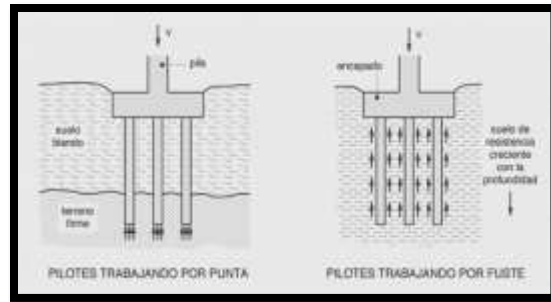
Tipos de pilotes. Nota Tomado de (Apuntes ingeniería civil, 2013)
